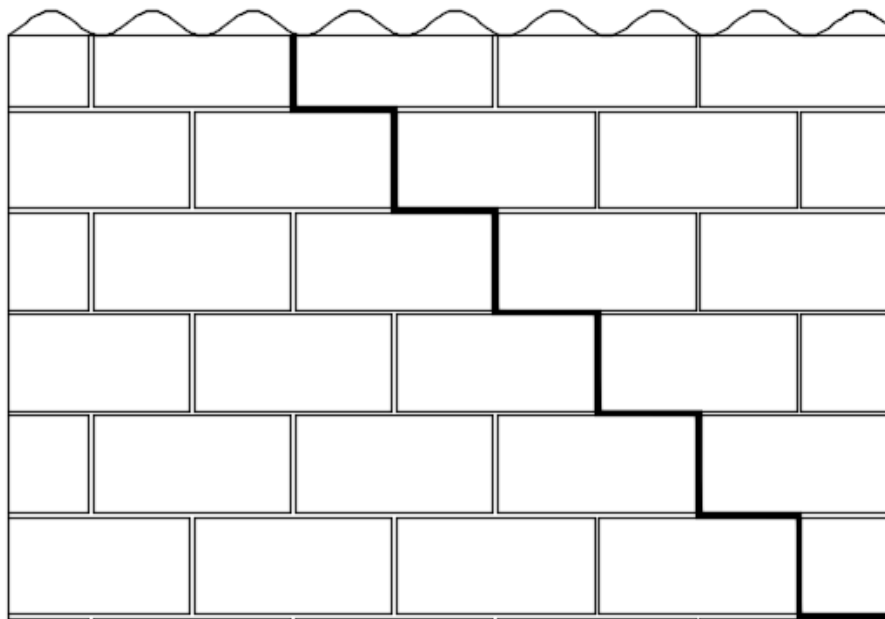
Trinca em muro de bloco de concreto acompanhando a argamassa de assentamento dos blocos. Fonte: autor.
